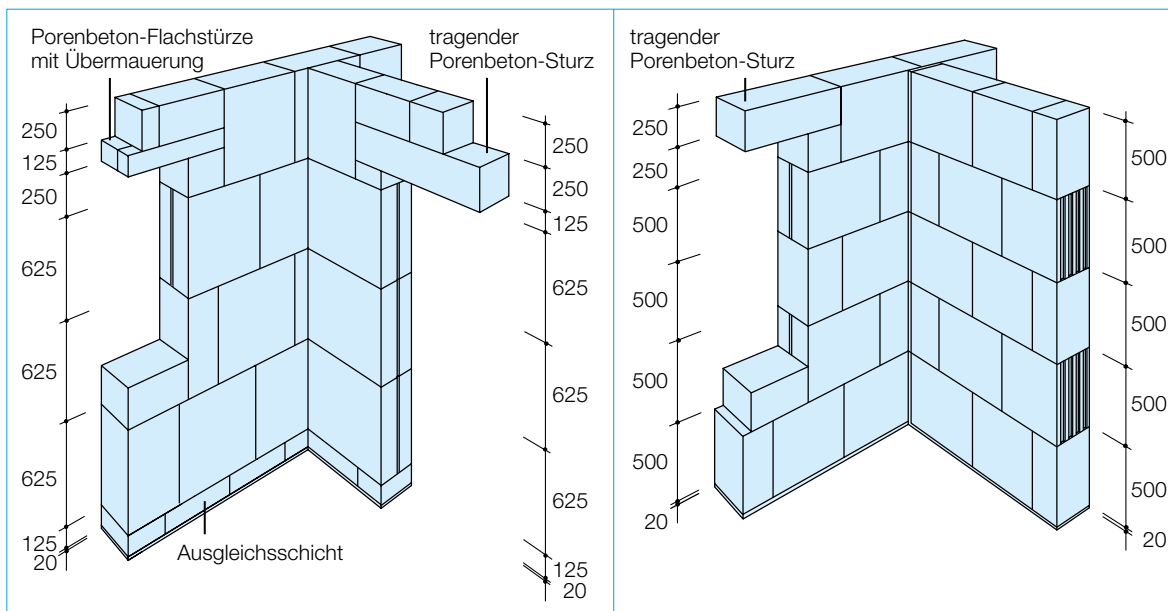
Planung der Geschosshöhe mit und ohne Höhenausgleichsschicht
